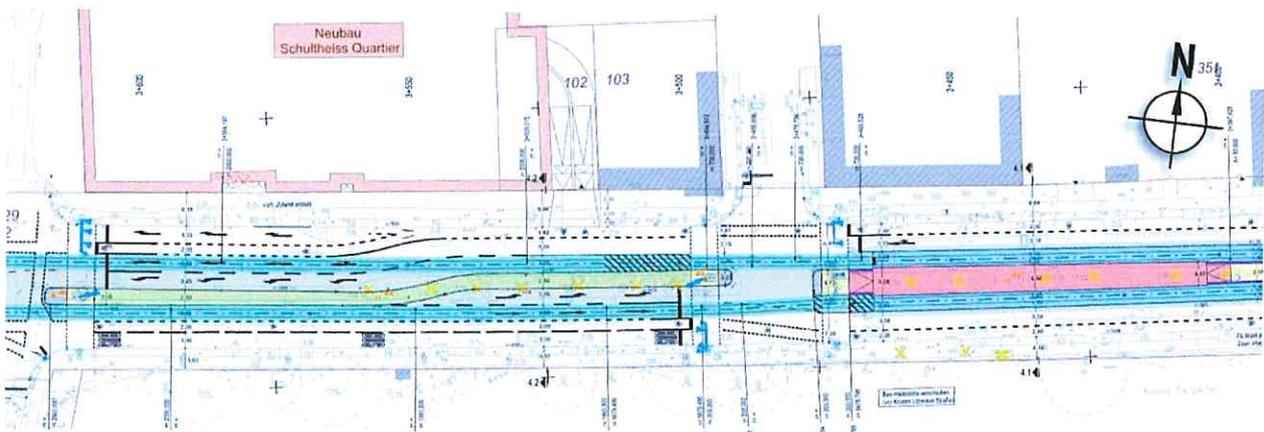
Lageplan Turmstraße, Haltestelle Turmstraße/Lübecker Straße
